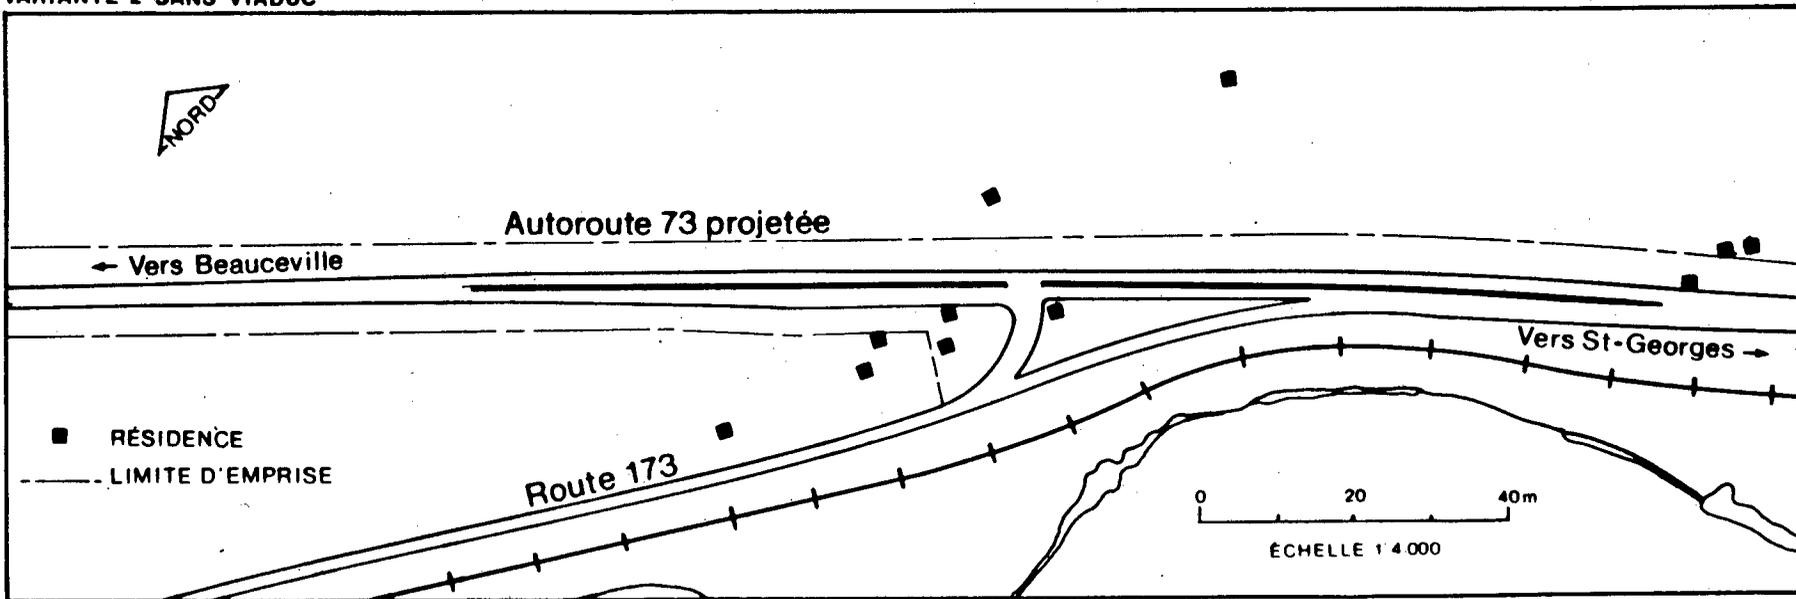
Vue en plan du raccordement de l'autoroute 73 à la route 173
